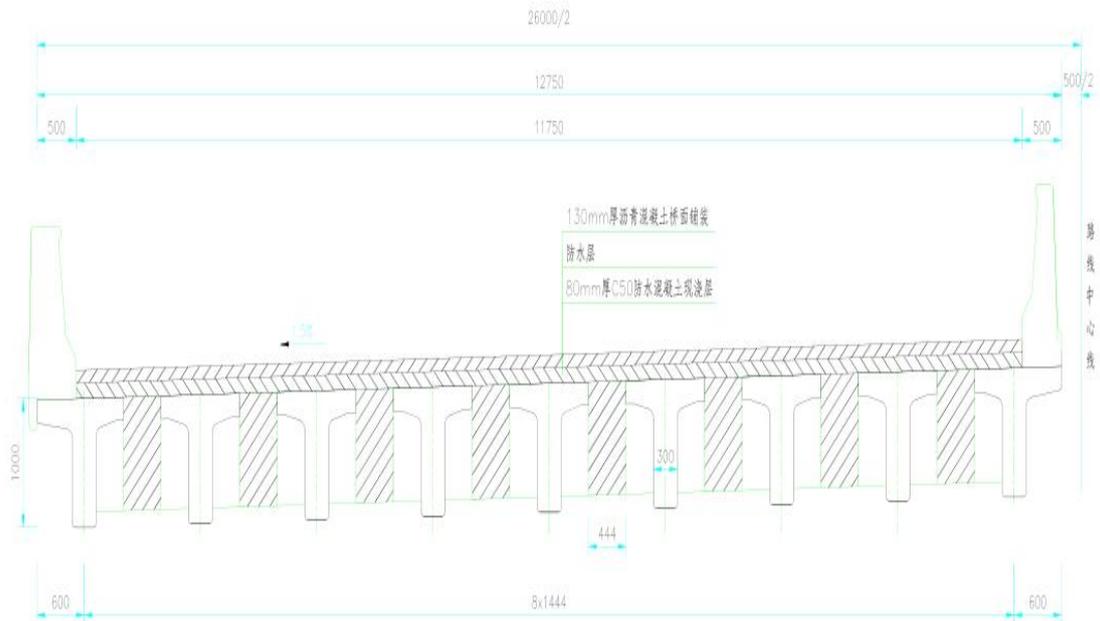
桥梁标准横断面图（矮 T 梁）
